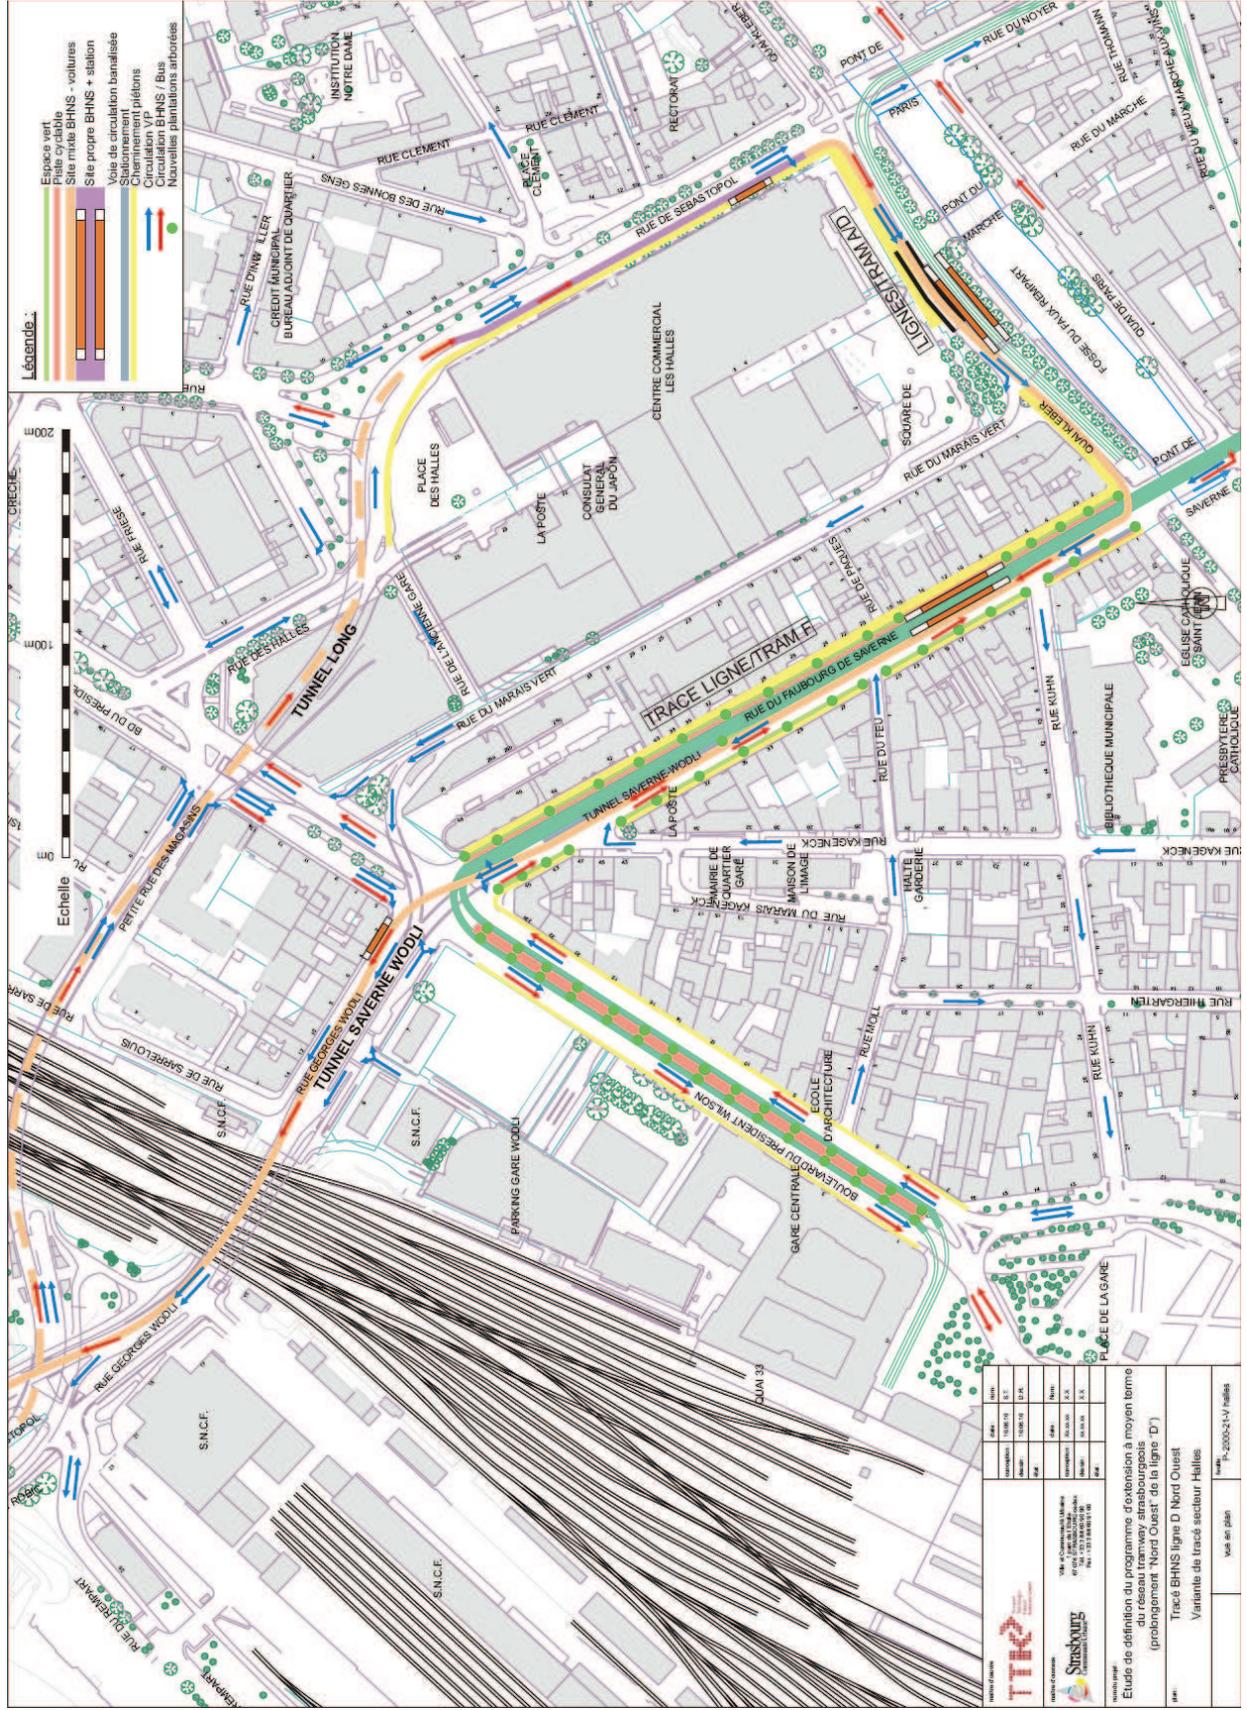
Plan d'insertion du secteur Halles (échelle 1/2500^{ème})
